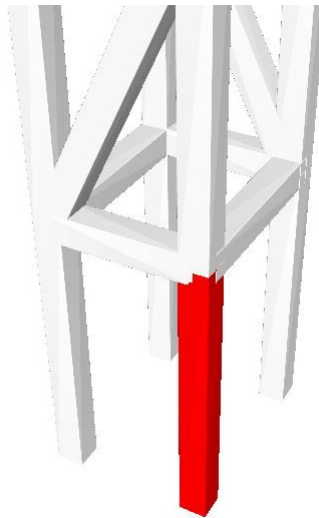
| *Barra de columna traccionada de pórtico extremo
